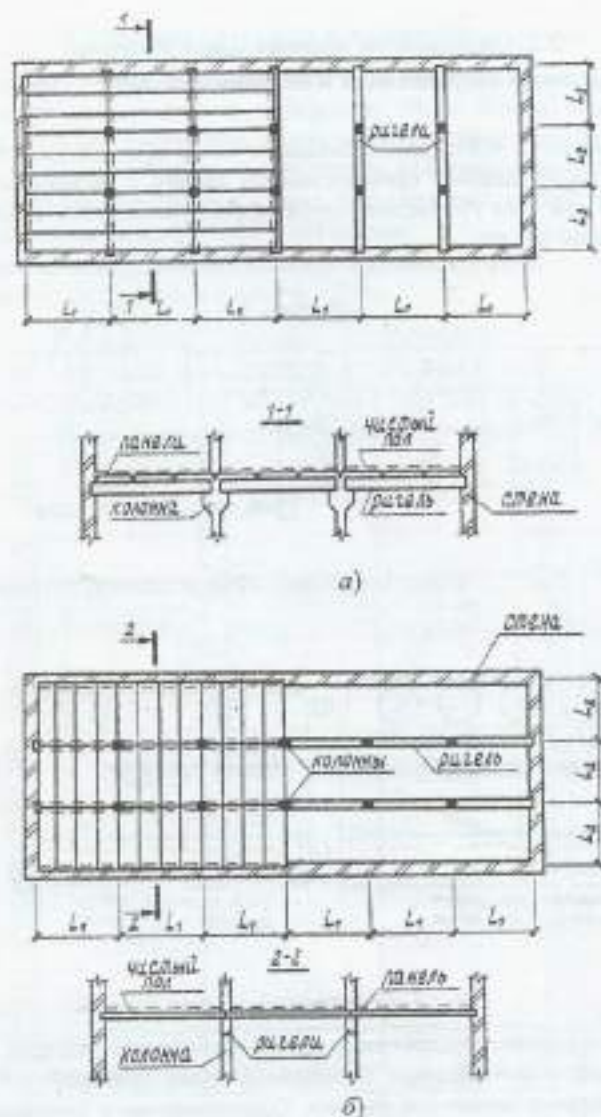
Варианты компоновки сборного балочного перекрытия:
